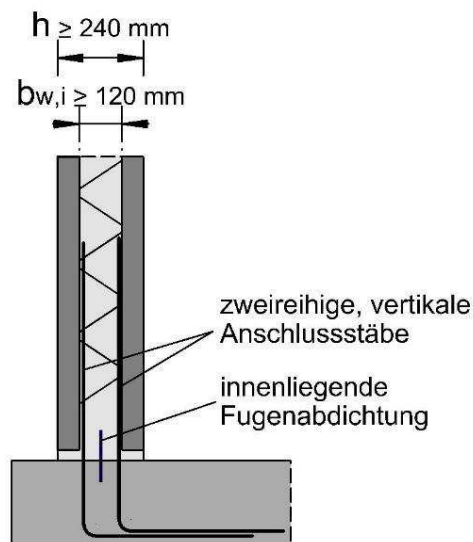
Elementwand mit Wanddicke von 240 mm und innenliegender Fugenabdichtung mit zweireihiger Anschlussbewehrung aus einzelnen vertikalen Bewehrungsstäben
